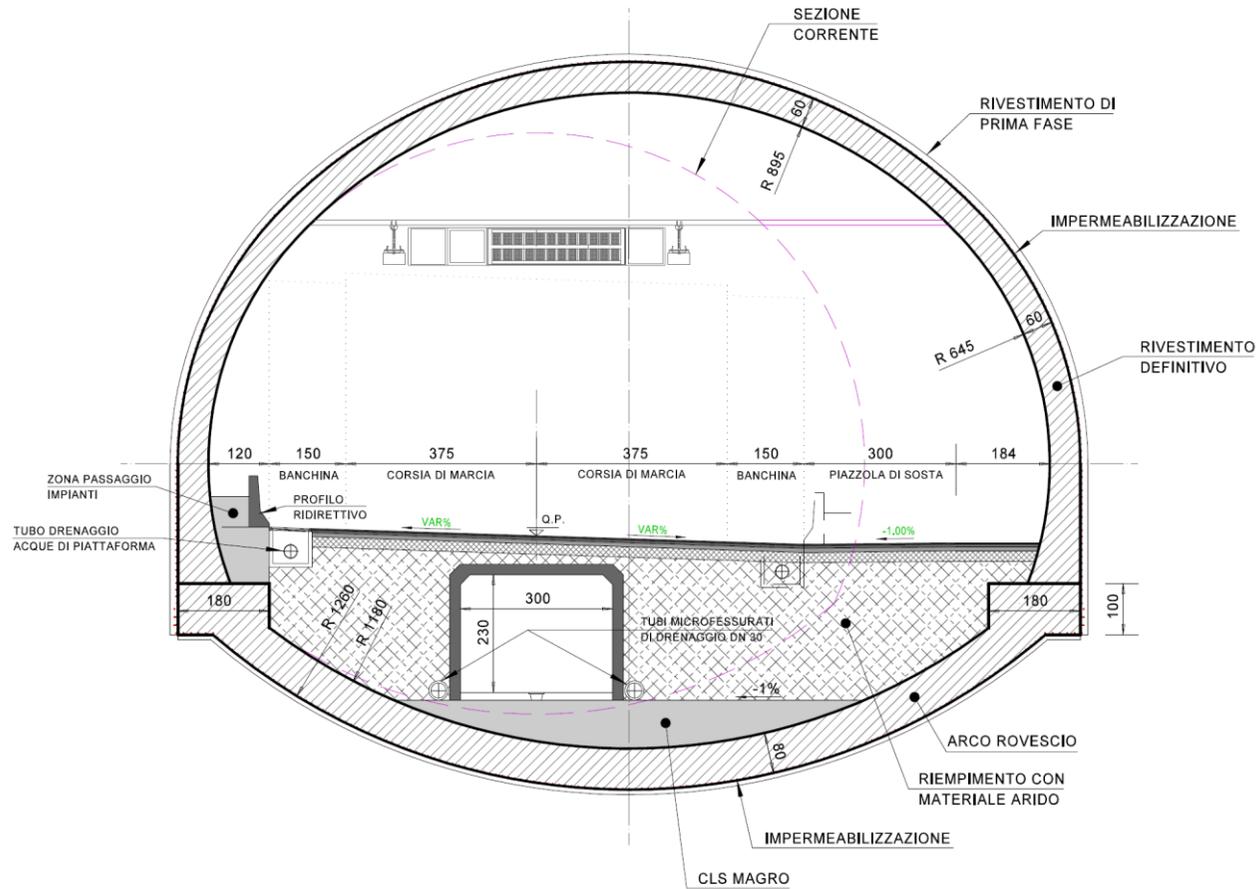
Galleria naturale - Sezione tipo con piazzola di sosta
